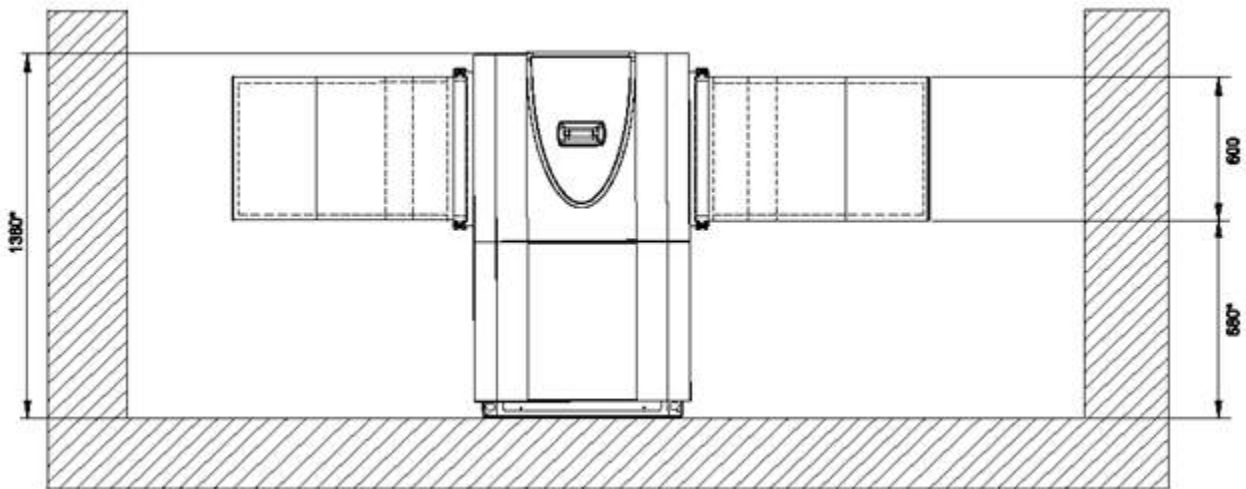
Vue de dessus - LI 11TES (Installation murale avec conduit d'air côté admission et échappement)
